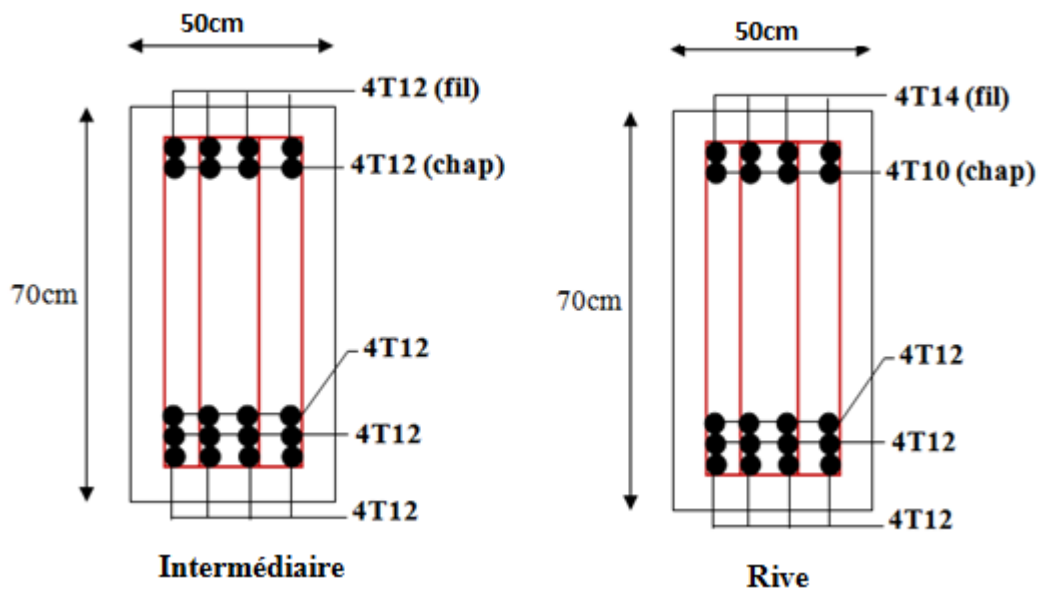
Ferrailage de la poutre de libage suivant le sens transversale.
